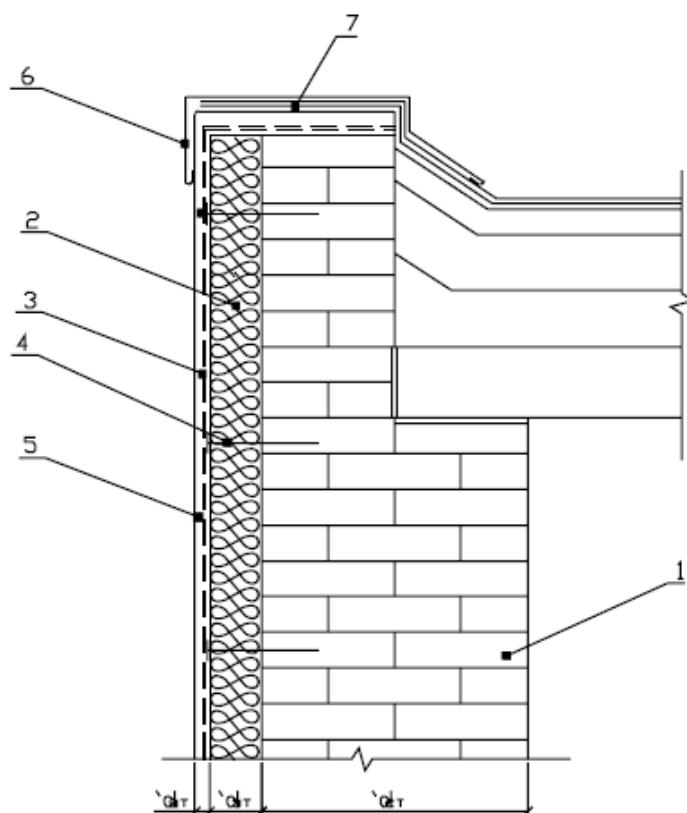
Кирпичная стена с утеплением из плит марки "ТЕРМОФАСАД" со штукатурным покрытием и жестким креплением теплоизоляционного слоя.
